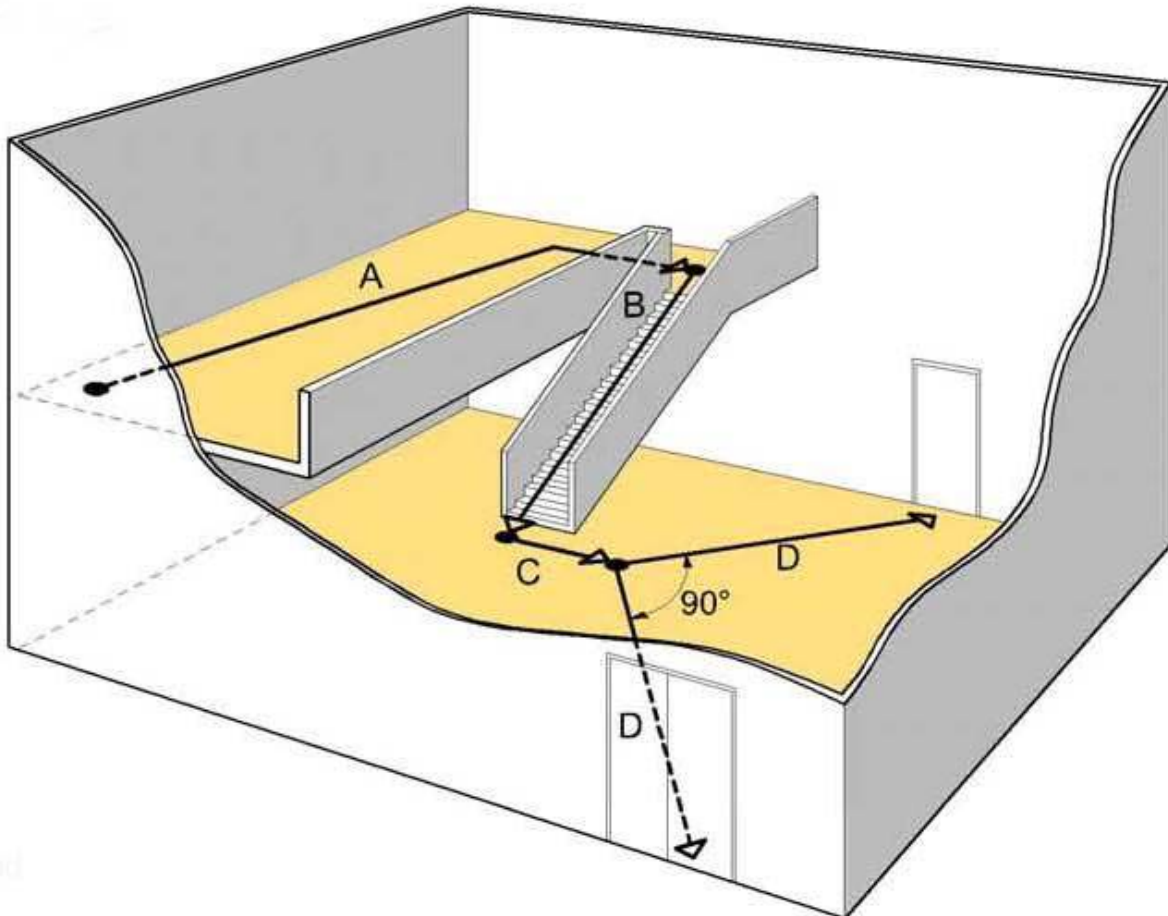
, evacuación de ambientes en mezzanines, cuando existan dobles alturas dentro de recintos en proyectos de arquitectura, imagen obtenida de Building Code Class C1, Fire Safety, Department of Building and Housing, Pagina 10
